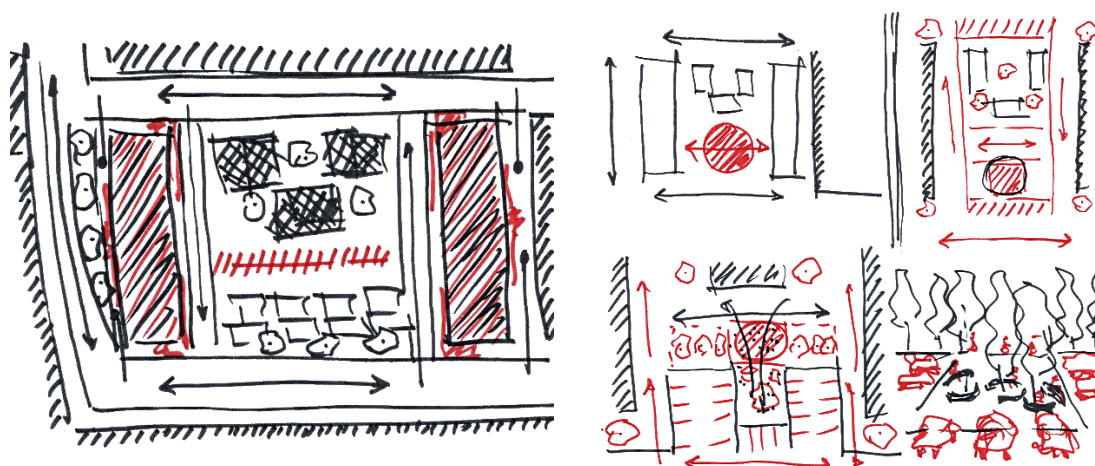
Estudo das ligações exteriores. Fonte: Desenhos da autora.
